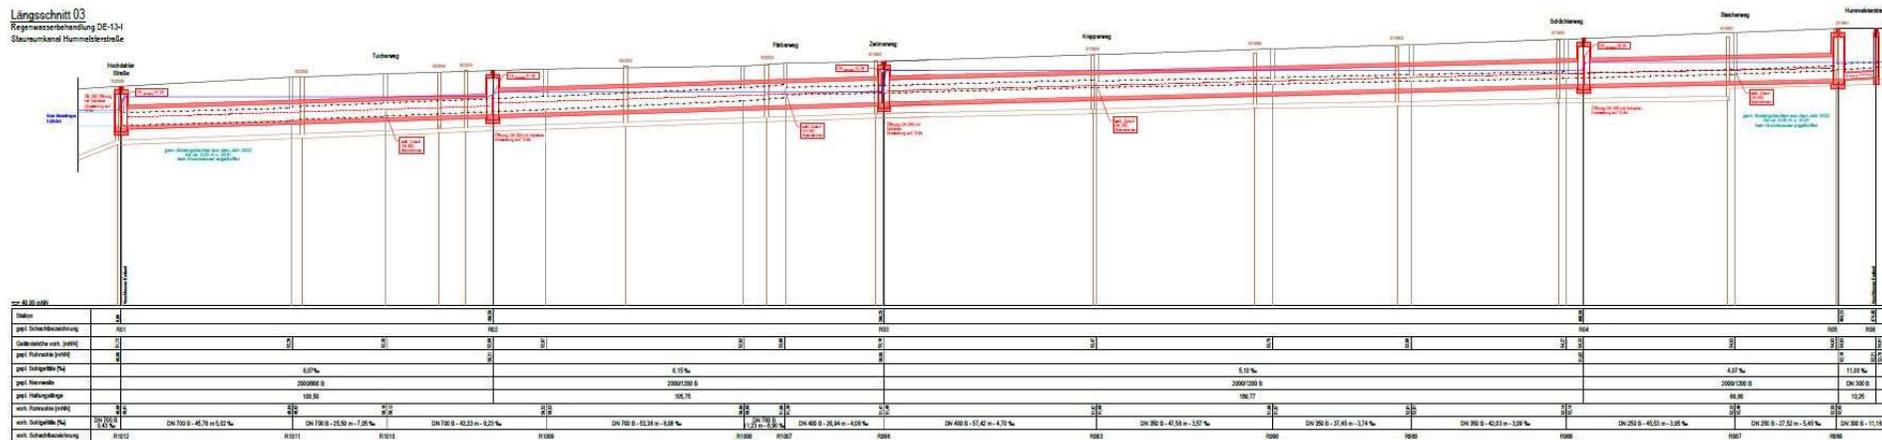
Längsschnitt Stauraumkanal Hummelsterstraße
